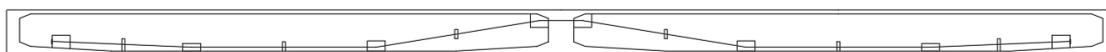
多跨连续布置体外预应力钢筋示意
